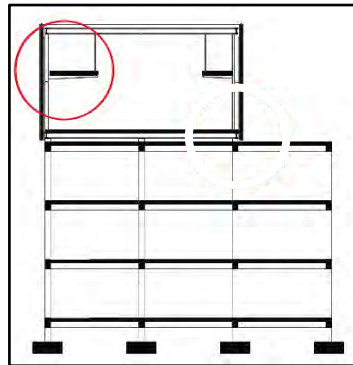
Detalle Estructural - Reposo viga metálica en columna de concreto
